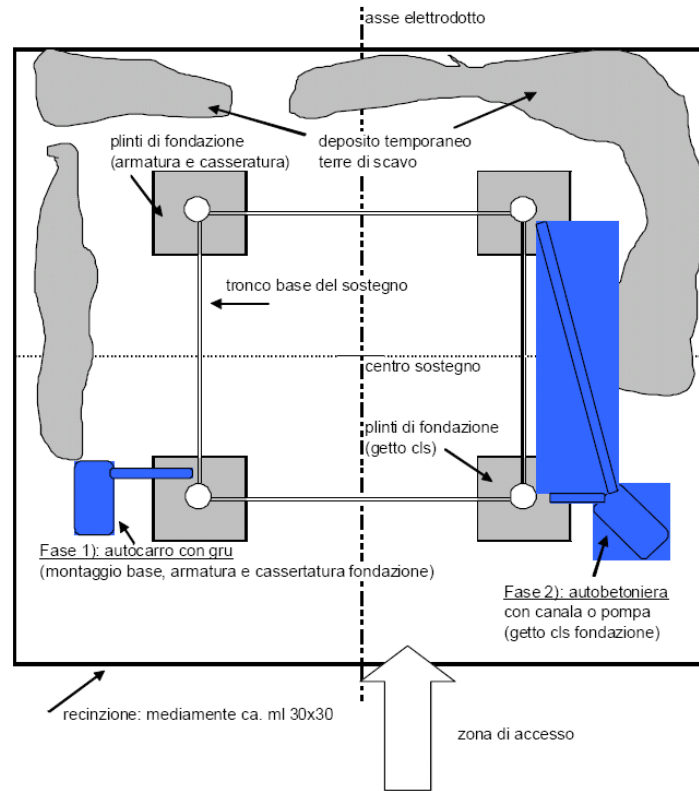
Planimetria dell'area di sostegno (getto e basi)
